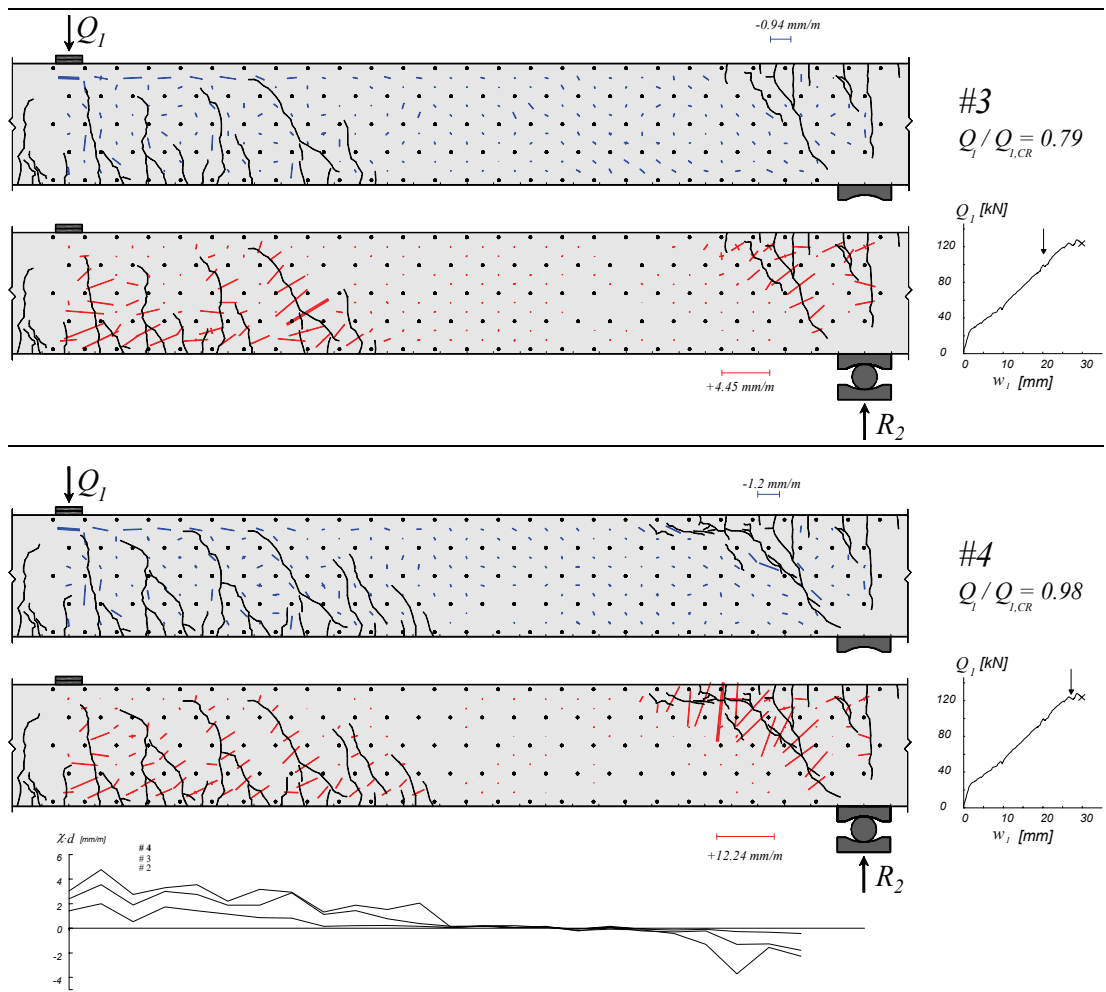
Poutre SR9: déformations principales, fissuration et courbures
